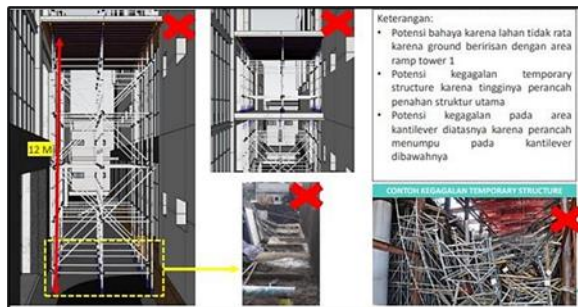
Denah Desain Eksisting Connecting Tower 1 dan Tower 2
